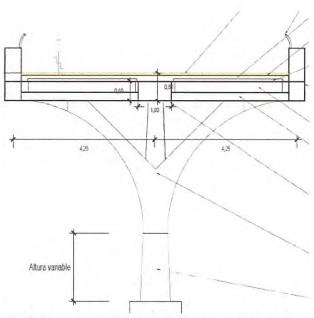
Columna de dos ramales con apoyo central formando un tridente. Fuente. Planos de proyecto, 2021.
